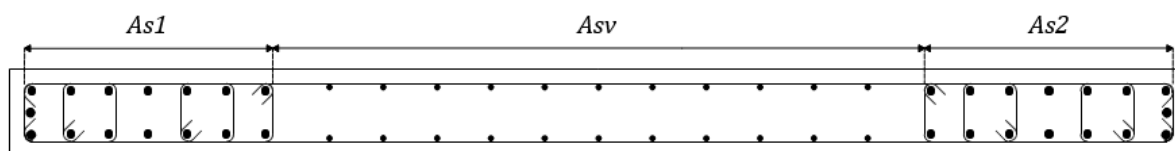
Armadura longitudinal nos elementos de extremidade (A_s) e na zona da alma (A_{sv})
